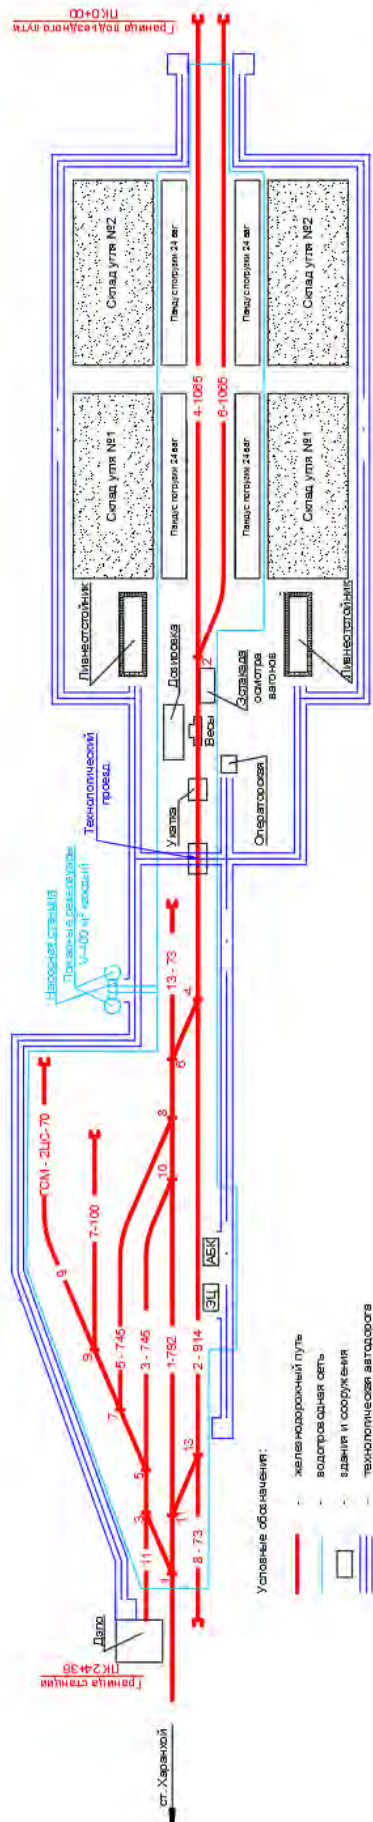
Схема генерального плана станции Угледогрузочная
